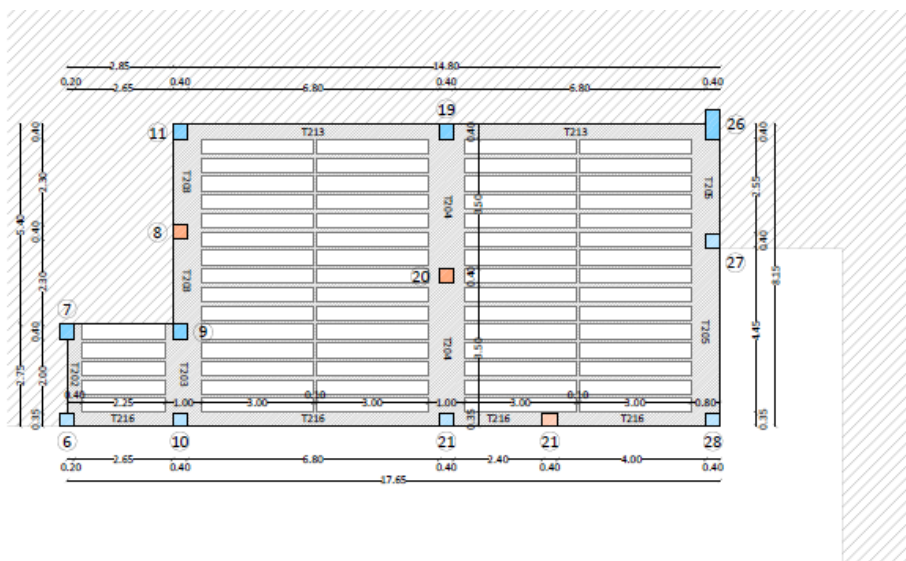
Blocco B-Planimetria Struttura Piano Soppalco.
